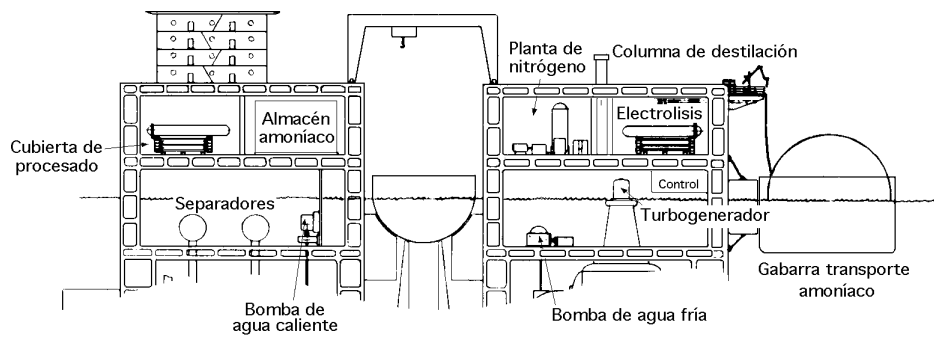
Vista seccionada de la planta de amoníaco de una central C.E.T.O.
